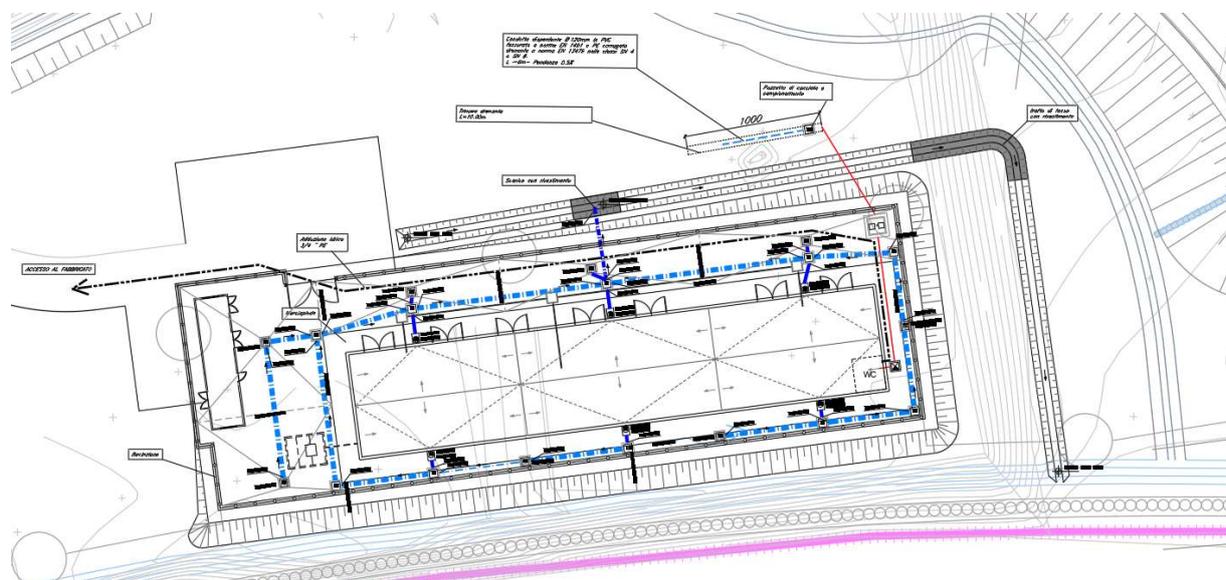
Stralcio planimetria di drenaggio Fabbricato FA01.
